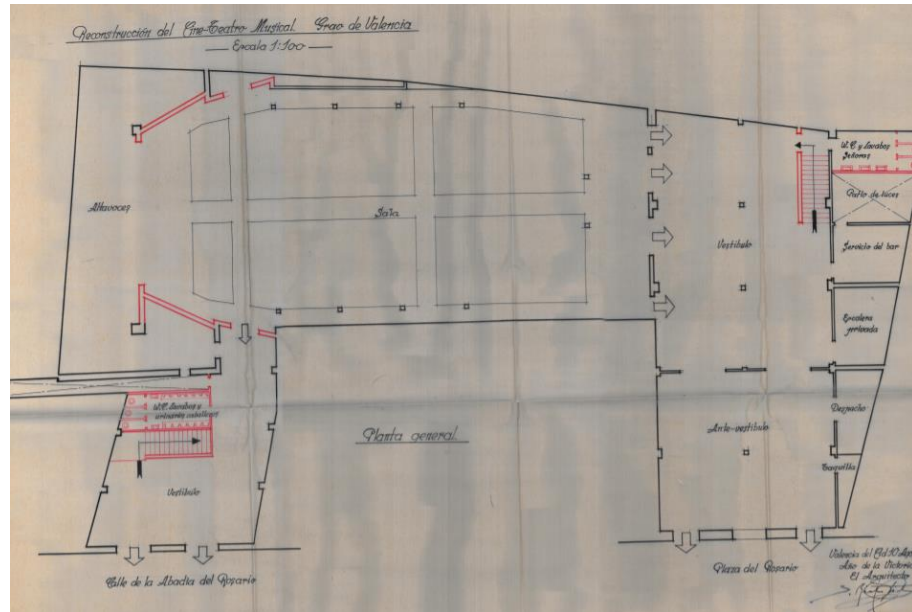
Plano planta baja de la reconstrucción del teatro Musical
